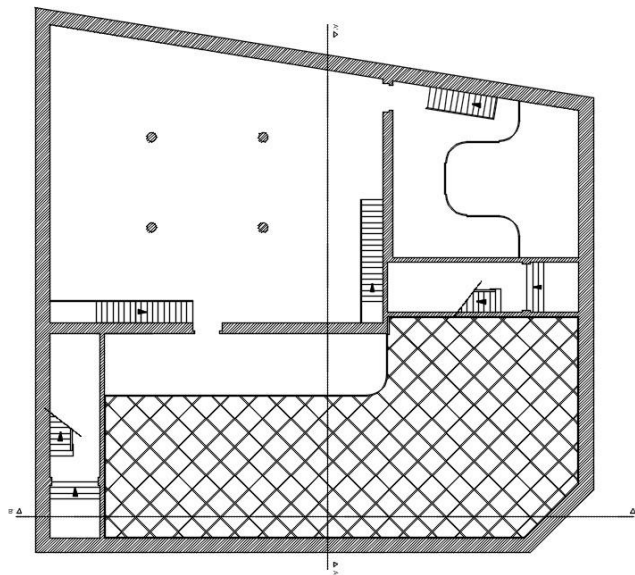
Planta Original do Piso 1. Fonte: Promotor Privado.
